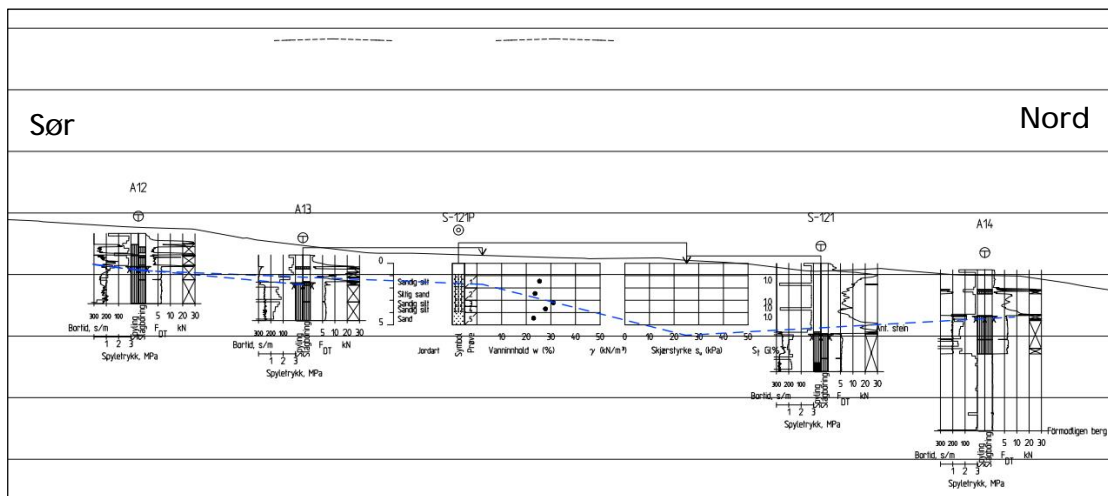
Omfang av grunnboringer ved planlagt tunnelpåkugg [11].
